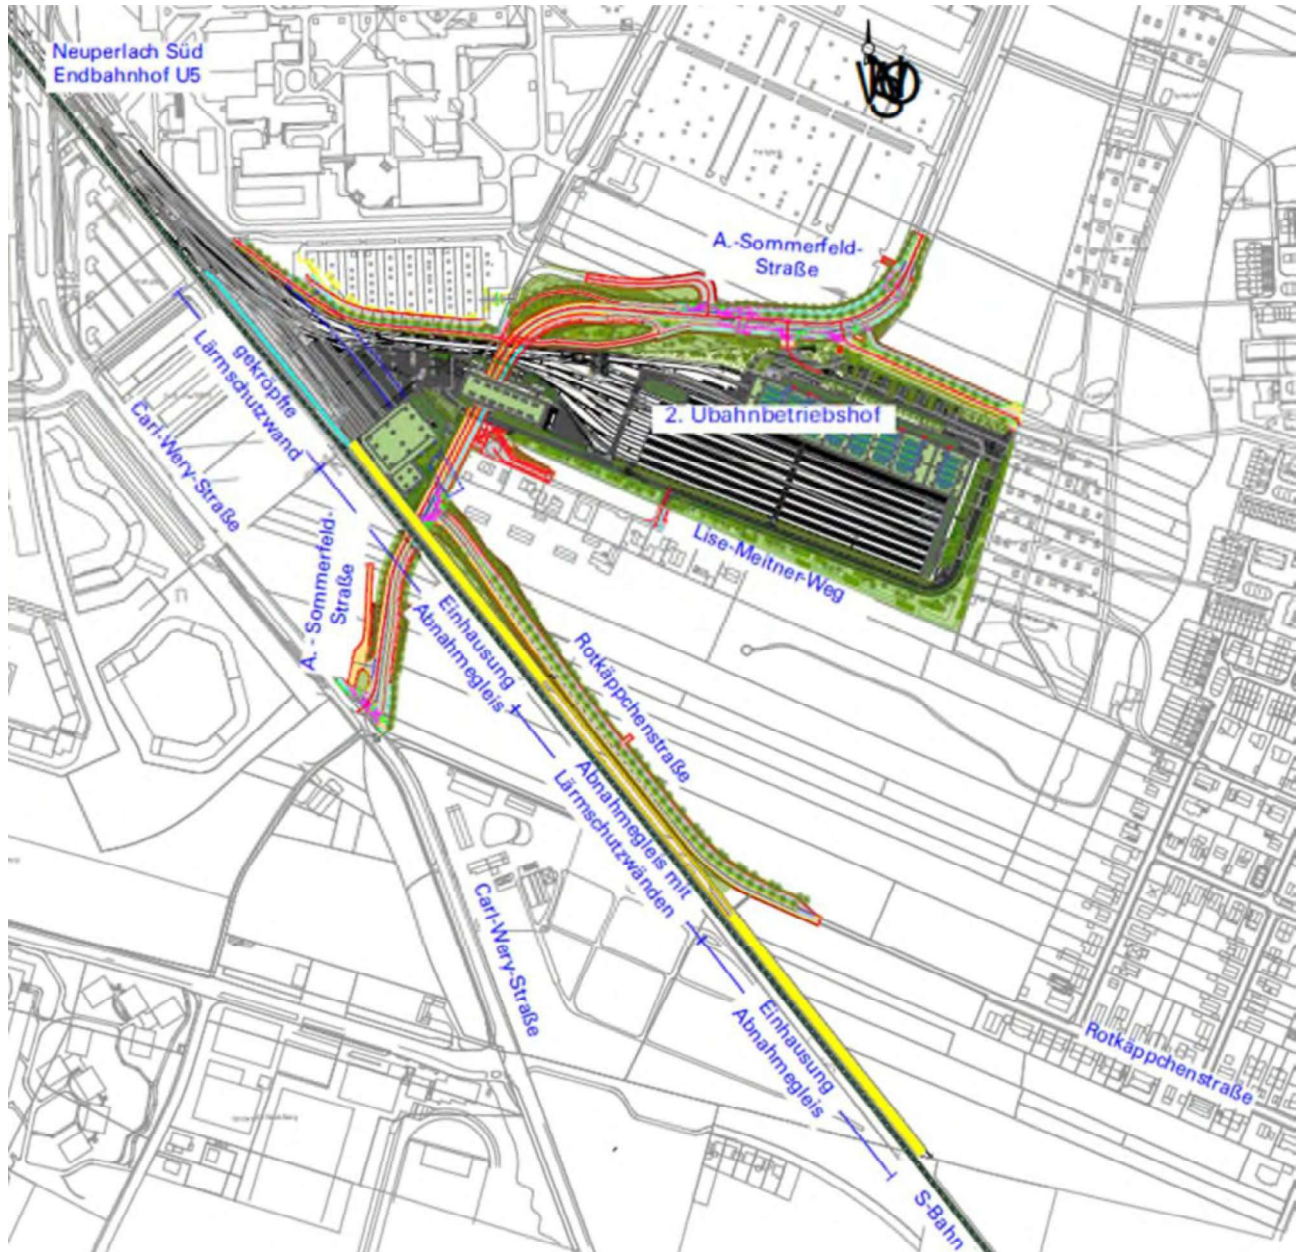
Übersichtslageplan U-Bahnbetriebs-hof Süd und öffentliche Erschließung (Quelle: Angebotsunterlagen SWM)
